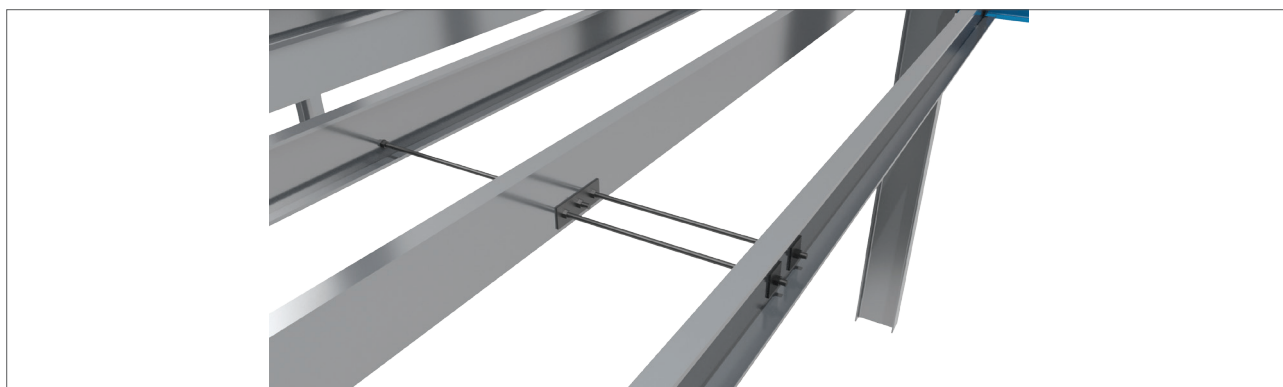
Pręt stabilizujący w ciężkiej konstrukcji stropowej
